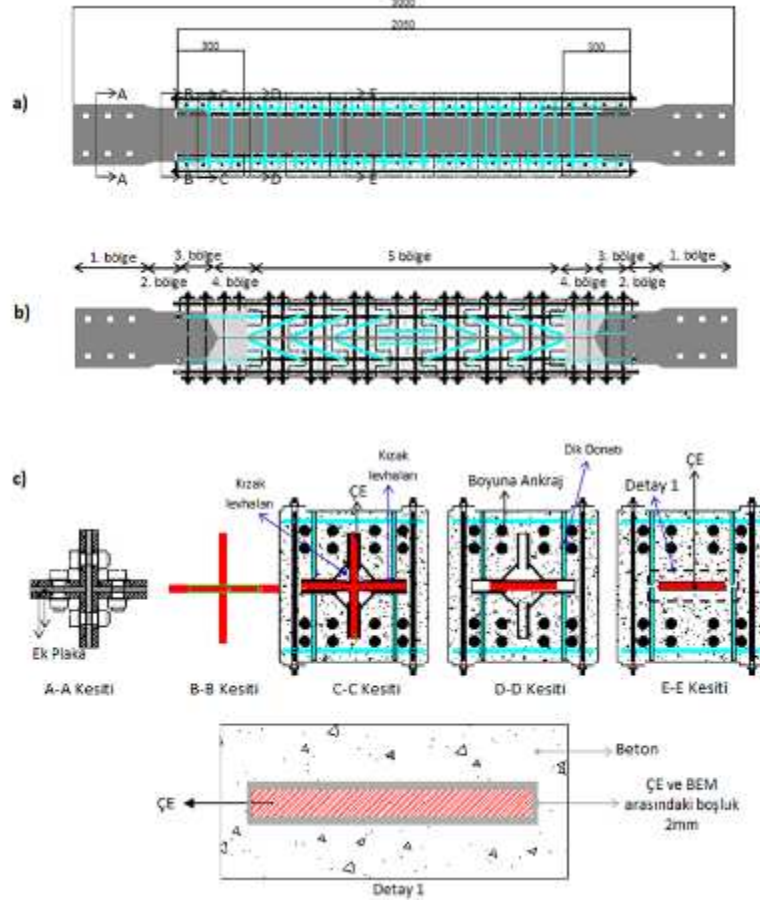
5. BEÇÇ\_3 elemanı detay çizimleri
